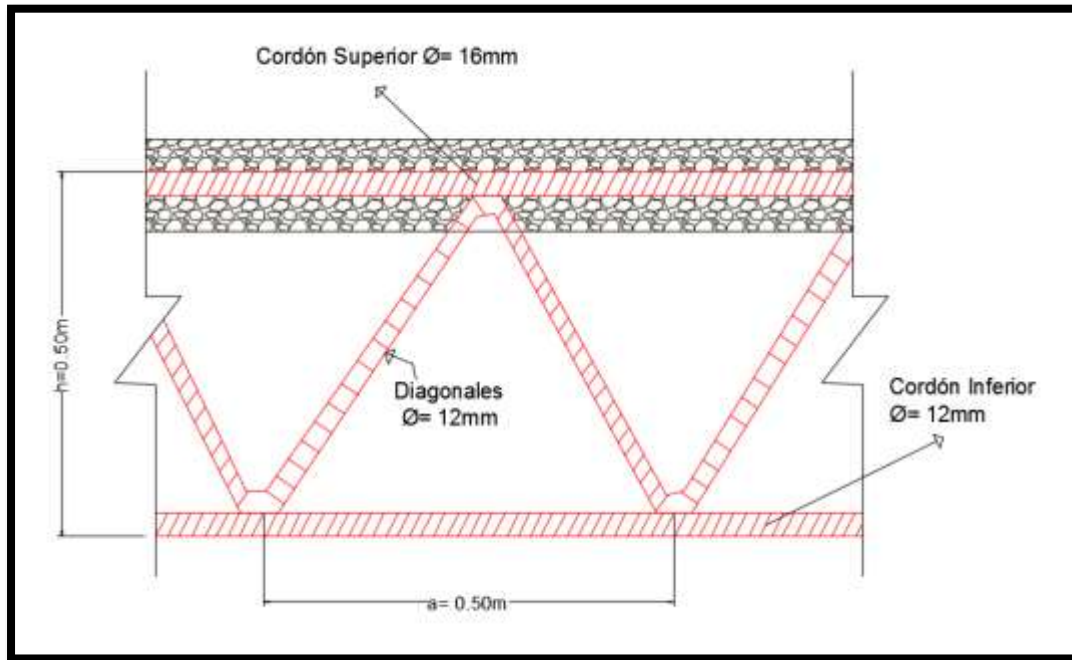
Detalle de una Sección de losa de Cubierta Circular
